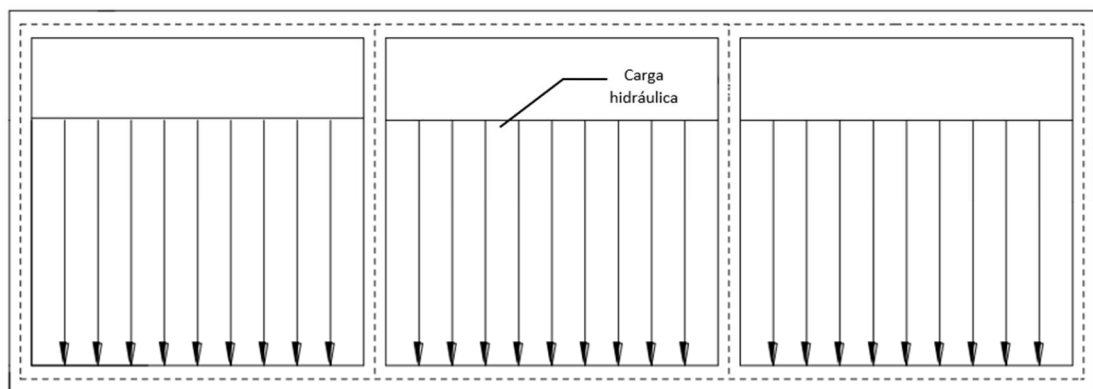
Esquema de carga hidráulica sobre alcantarilla. Fuente: Autor.
